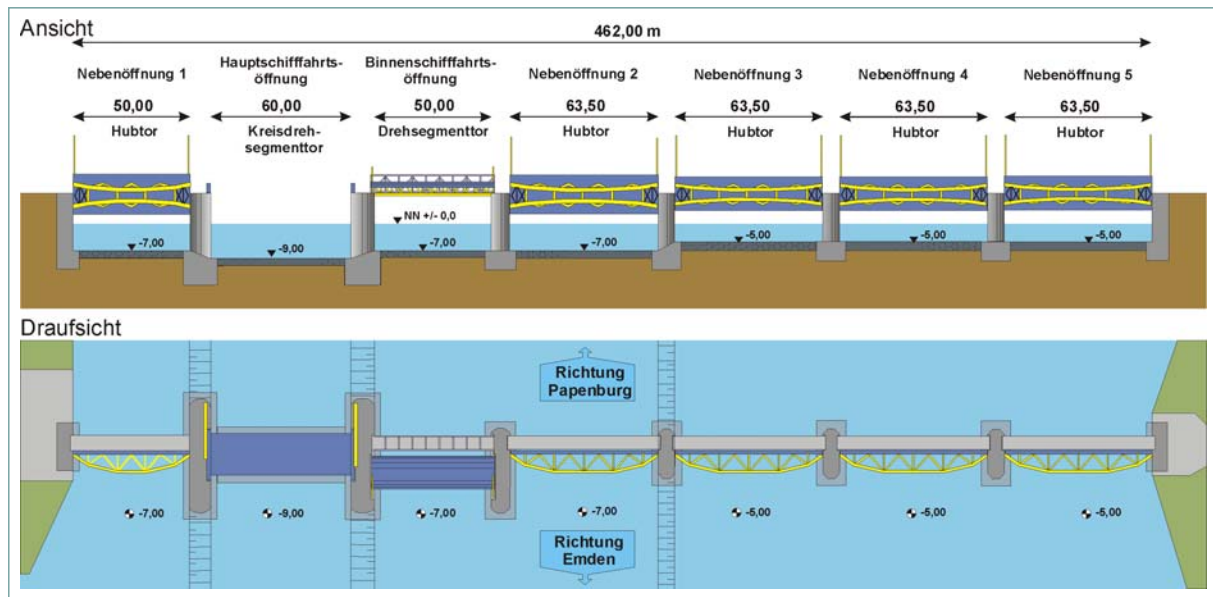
Grundriss und Ansicht des Emssperrwerkes
